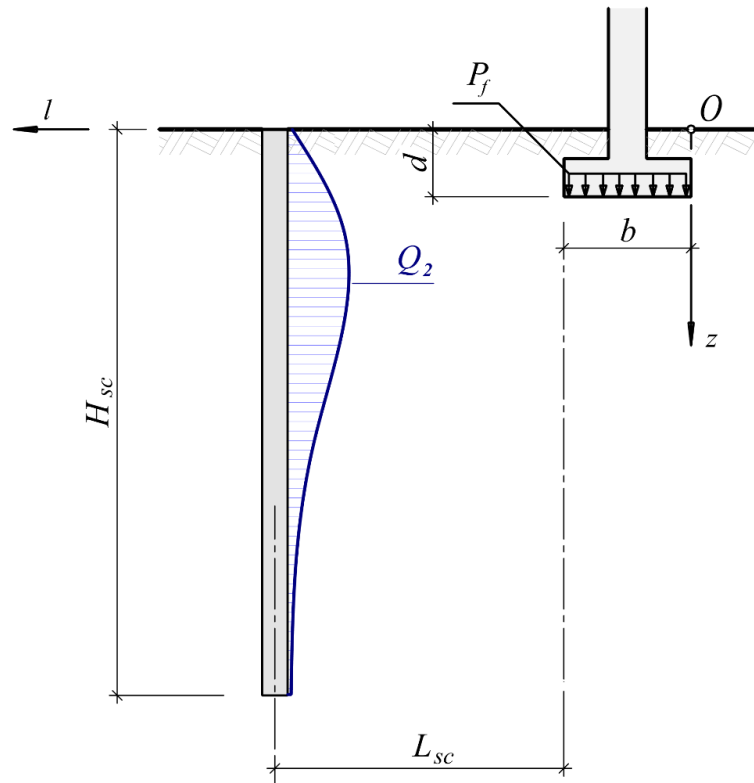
Схема нагрузок на экран со стороны фундамента
